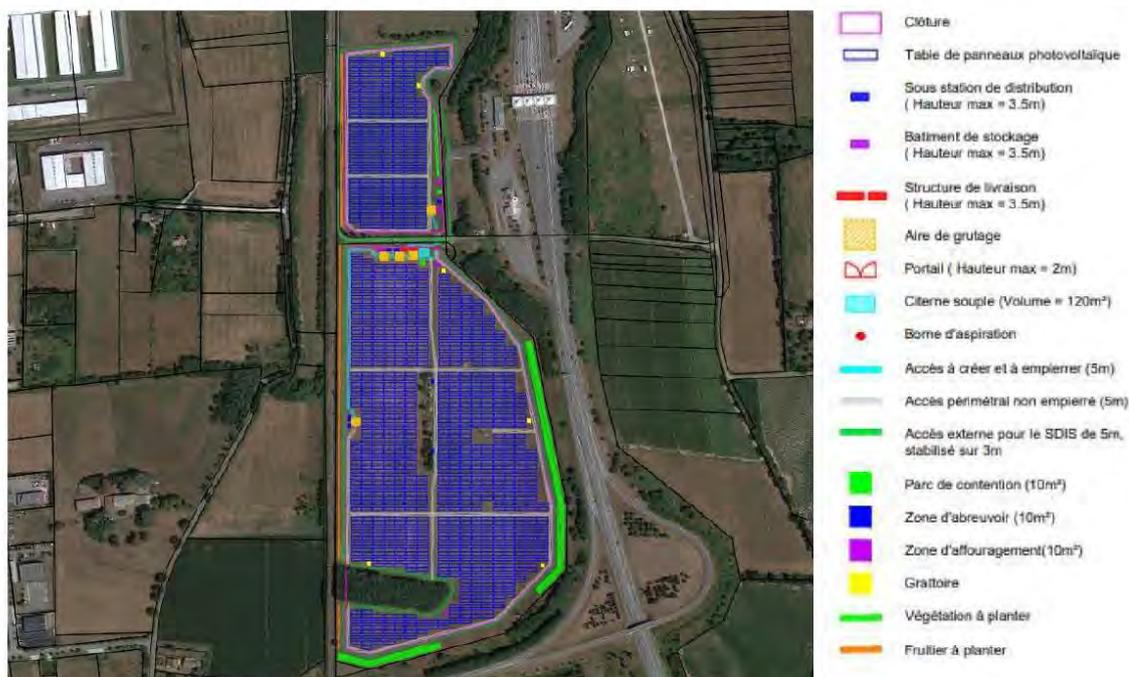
plan de masse du parc – orthophoto – extrait de l'étude d'impact
